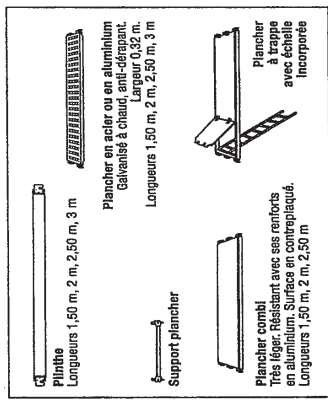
Plancher d'échafaudage à cadres préfabriqués.
